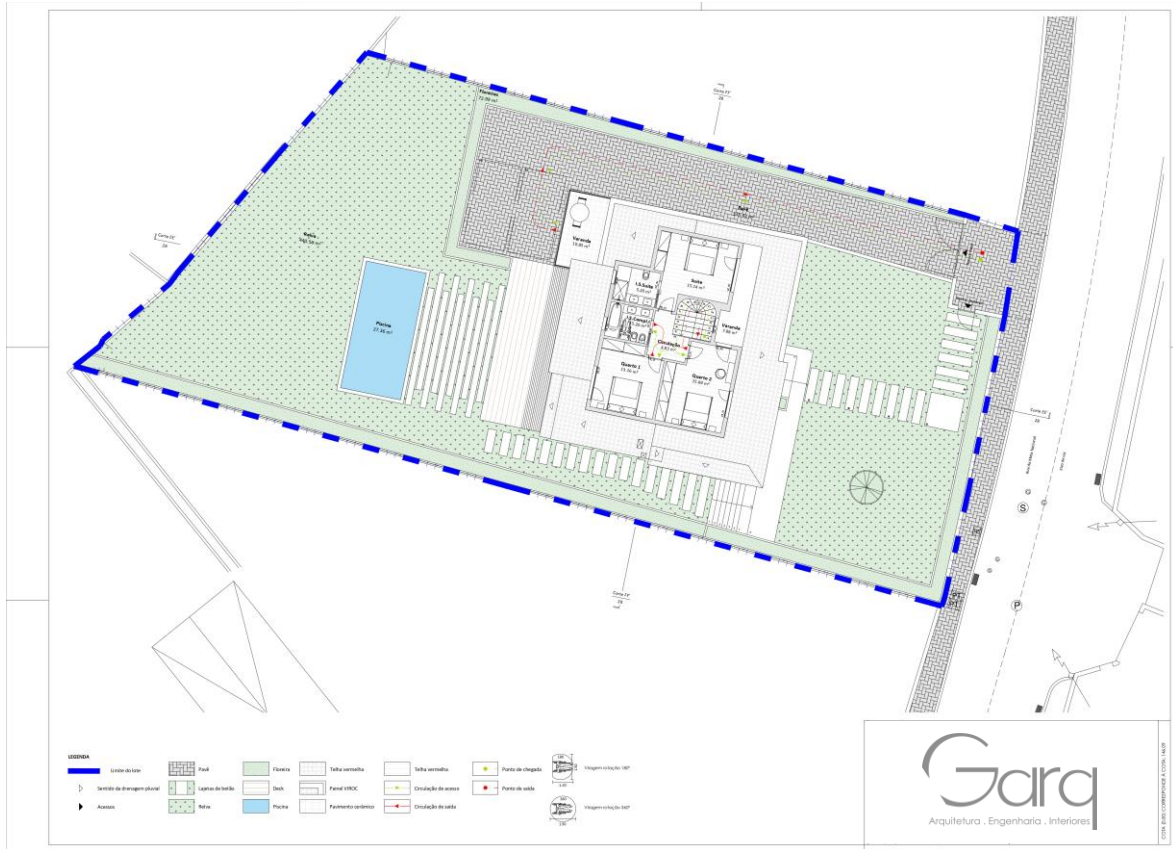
Proposto - Planta de acessibilidades do piso 1 (LIC_R00). Fonte: Garq / Desenvolvimento: Autora.
